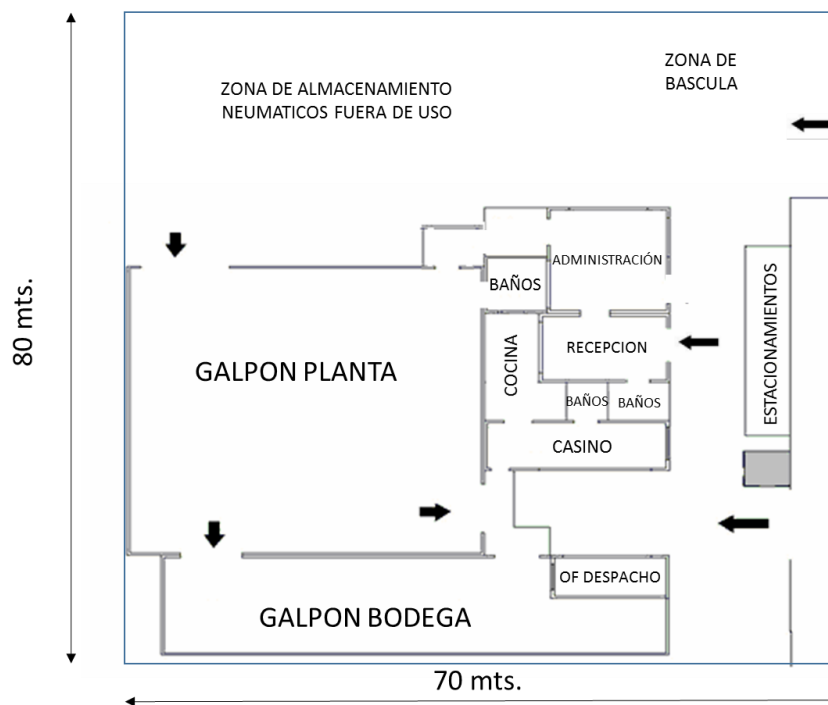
Propuesta de Layout de la planta. Fuente: elaboración propia
